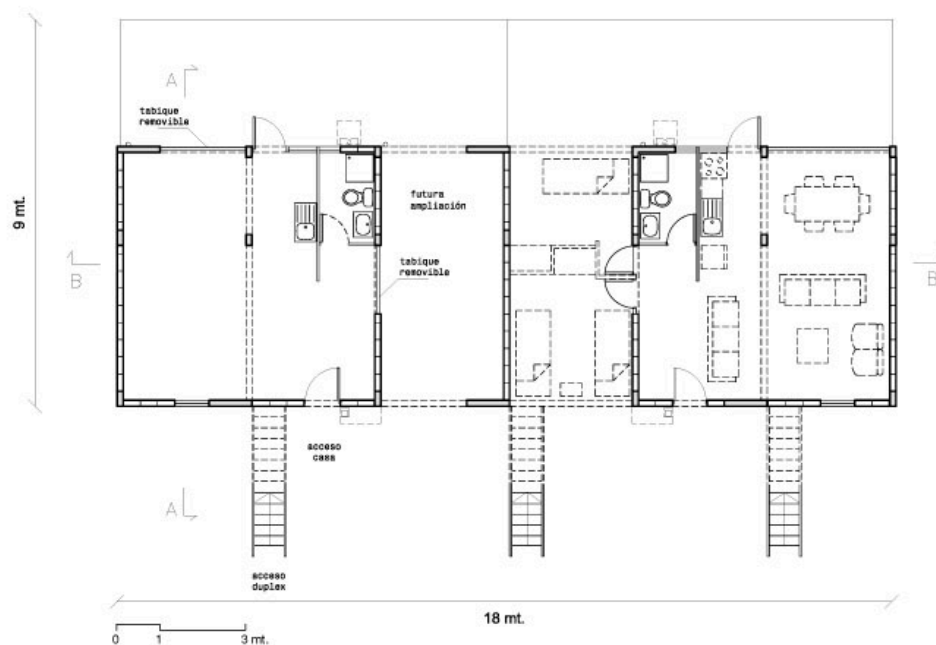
Planta do projeto em Iquique. Fonte: ArchDaily: Quinta Monroy / ELEMENTAL
